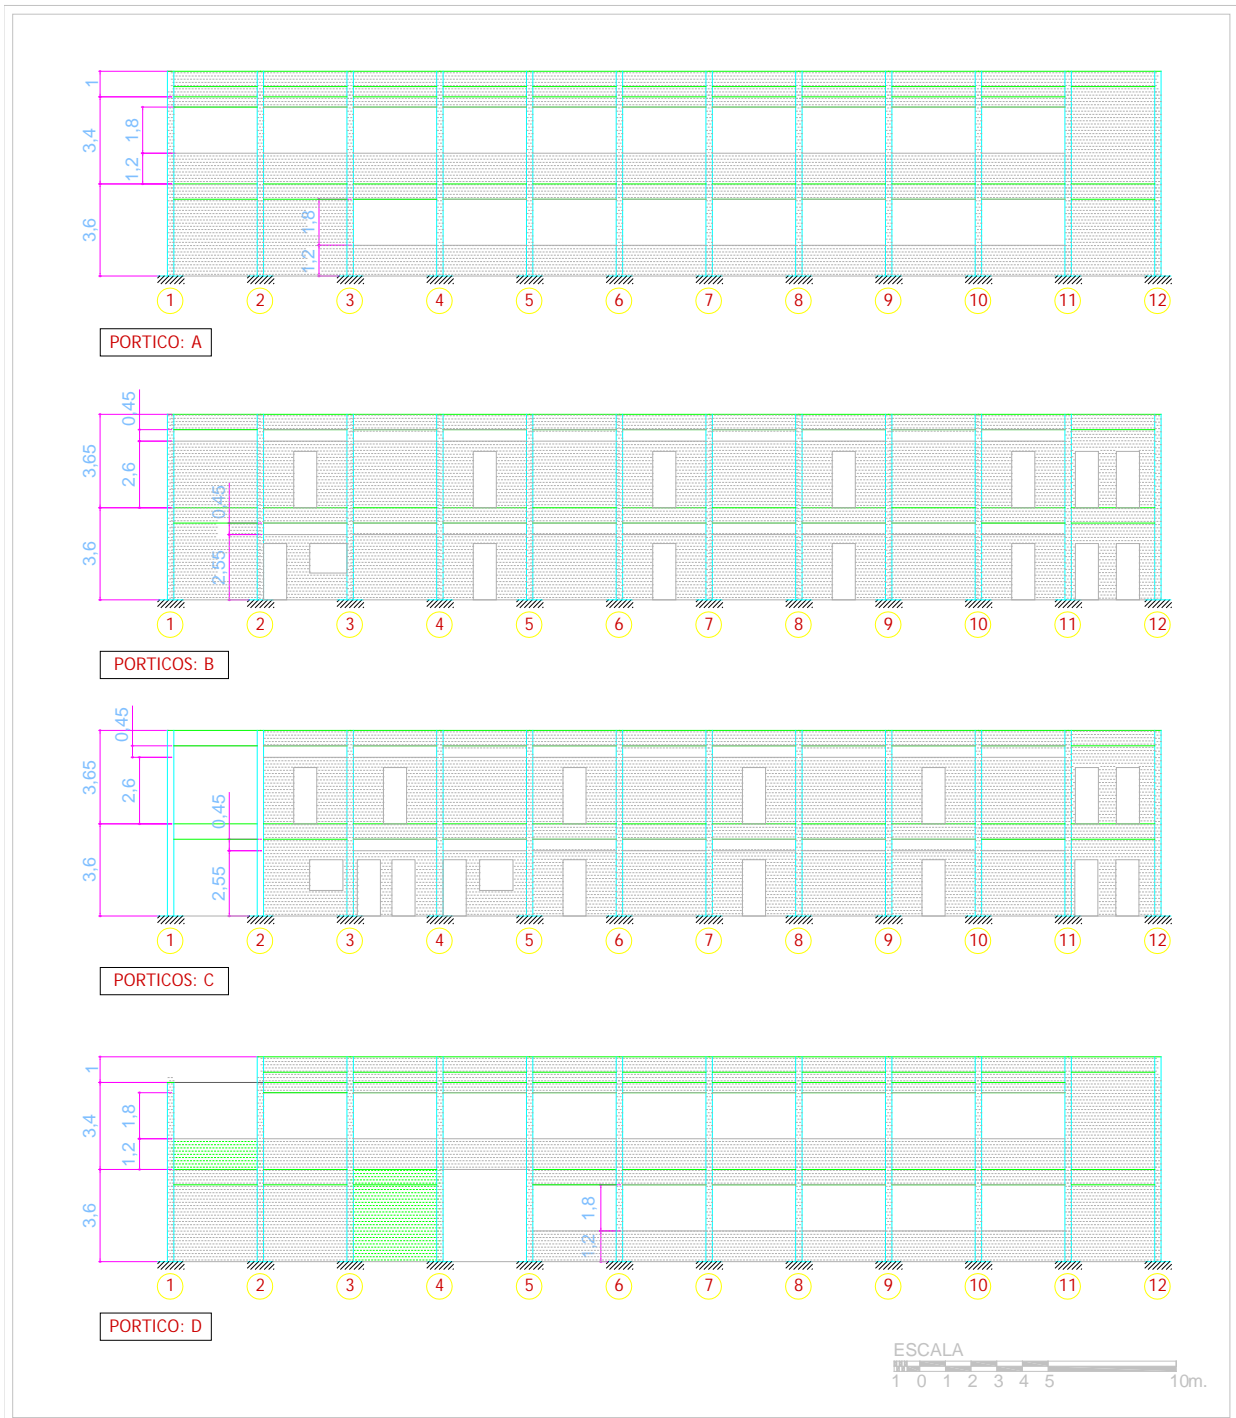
Pórticos longitudinales (Y) del Módulo Principal mostrando las paredes de mampostería y la longitud efectiva de las columnas.
